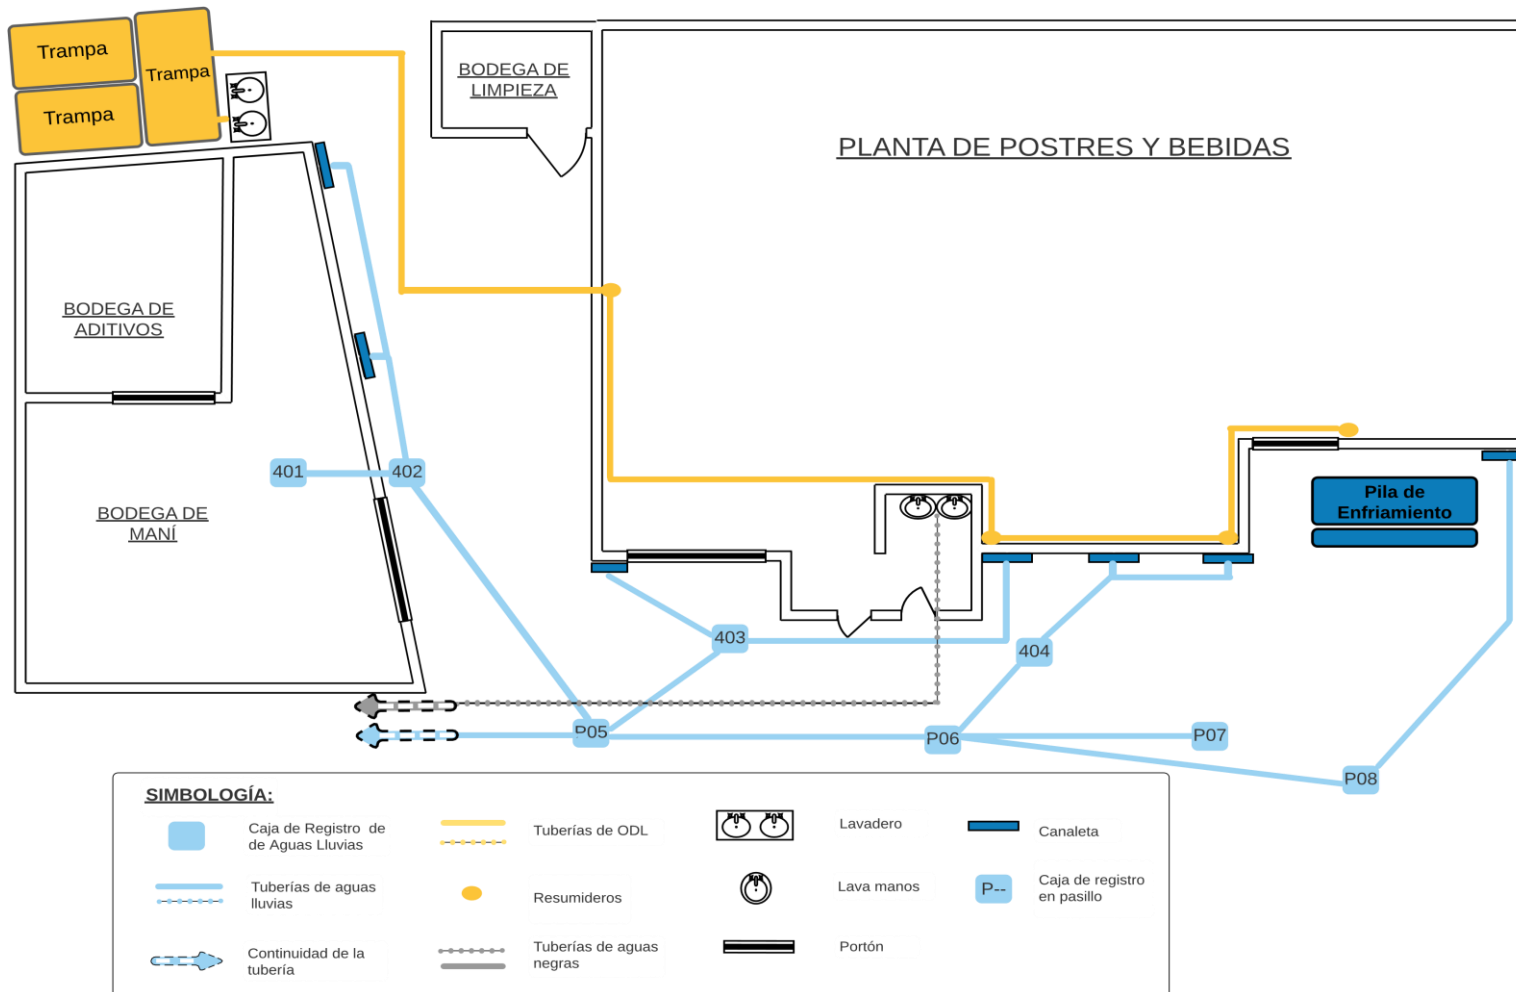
Ilustración de distribución de la Red de Alcantarillado de la Planta Postres y Bebidas.
